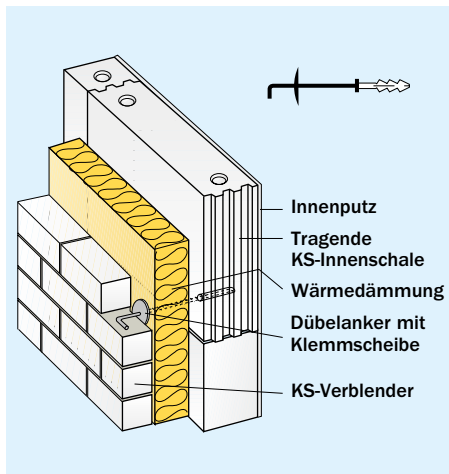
Systemaufbau zweischaliges Mauerwerk mit Wärmedämmung
